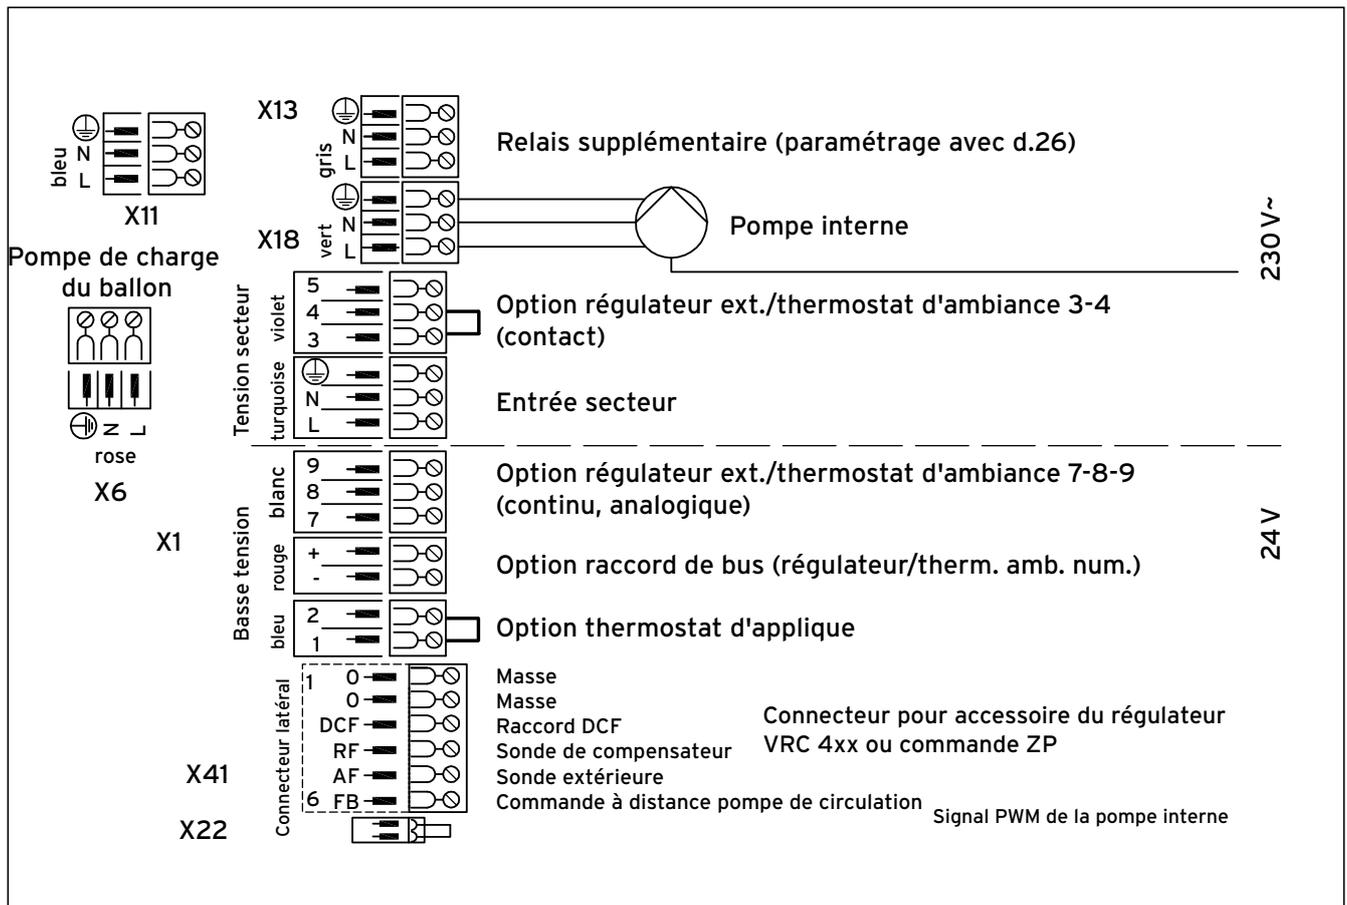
Plan de raccordement de l'appareil ecoTEC exclusiv (suite)
